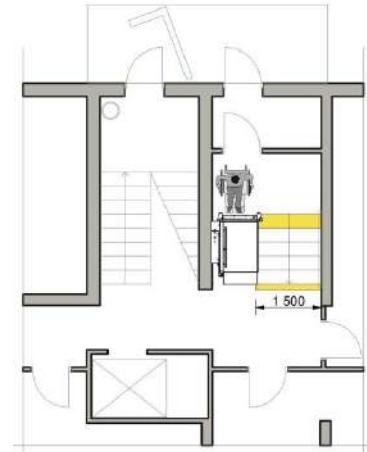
Площадка перед лестницей для размещения платформы и прямого заезда на нее
